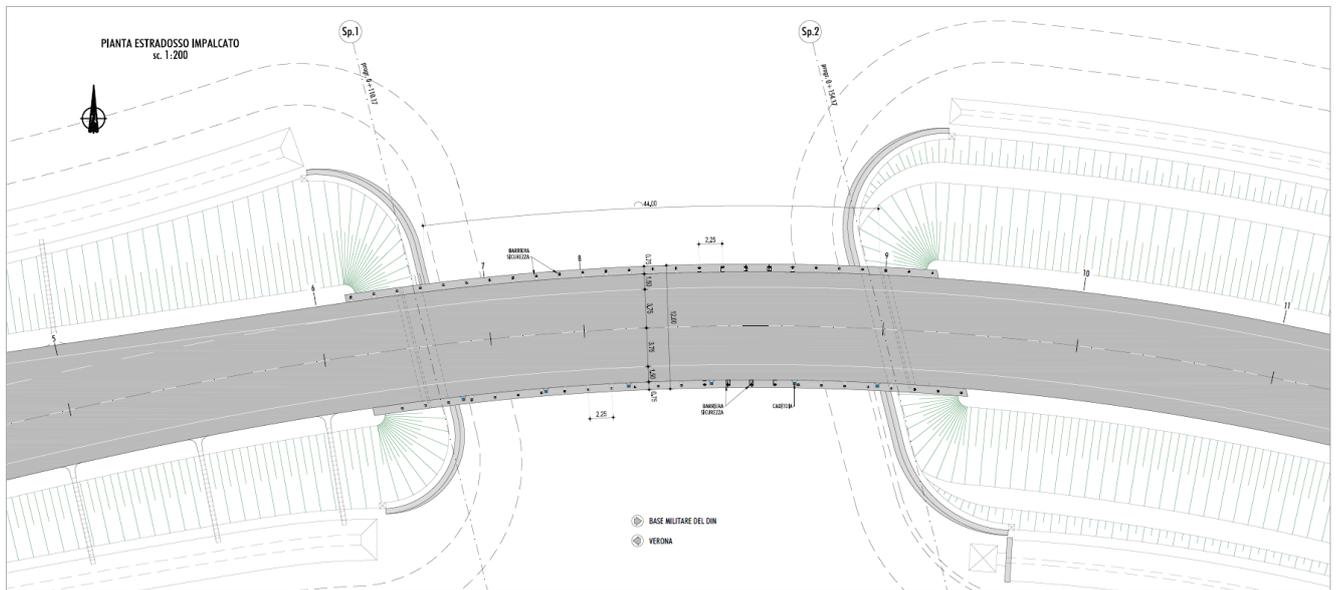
VISTA IN PIANTA DEL PONTE – LIVELLO IMPALCATO
